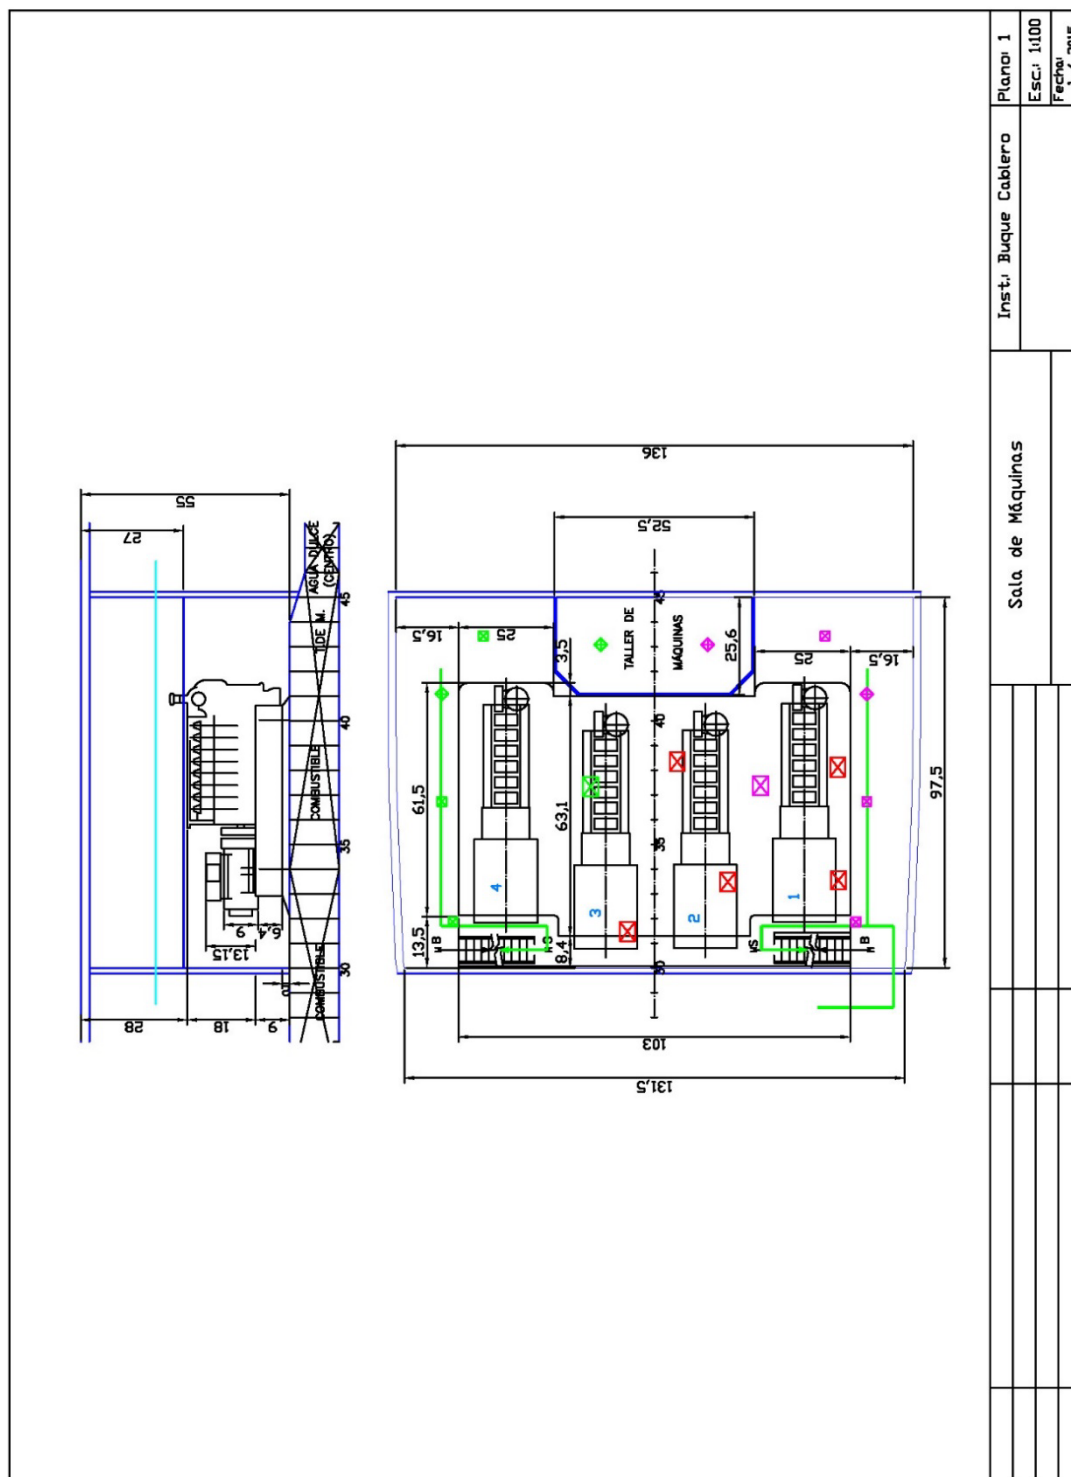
Plano Constructivo de la Sala de Máquinas.
